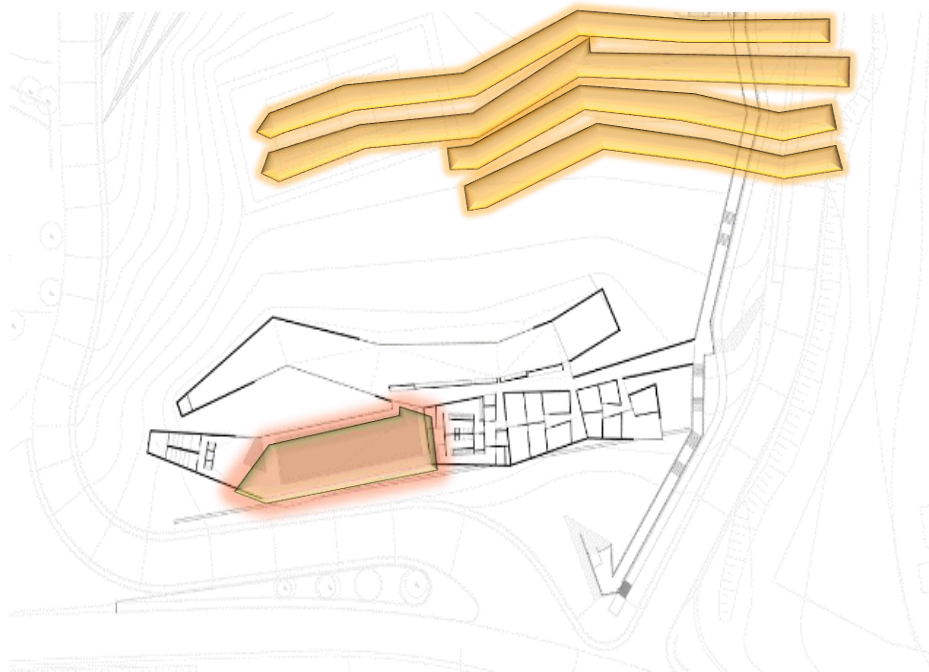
Vista en planta tercer nivel al doceavo centro Remo Do Pocinho
